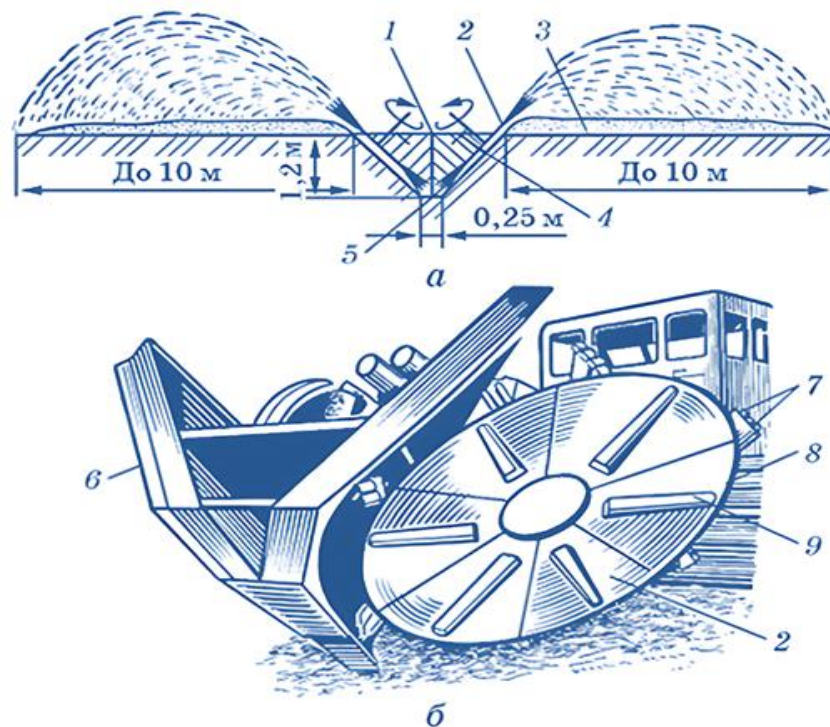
Фрезерний каналокопач КФН-1200А: а – технологічна схема; б – робочий орган; 1 – ніж відвала; 2 – фреза; 3 – насипний
